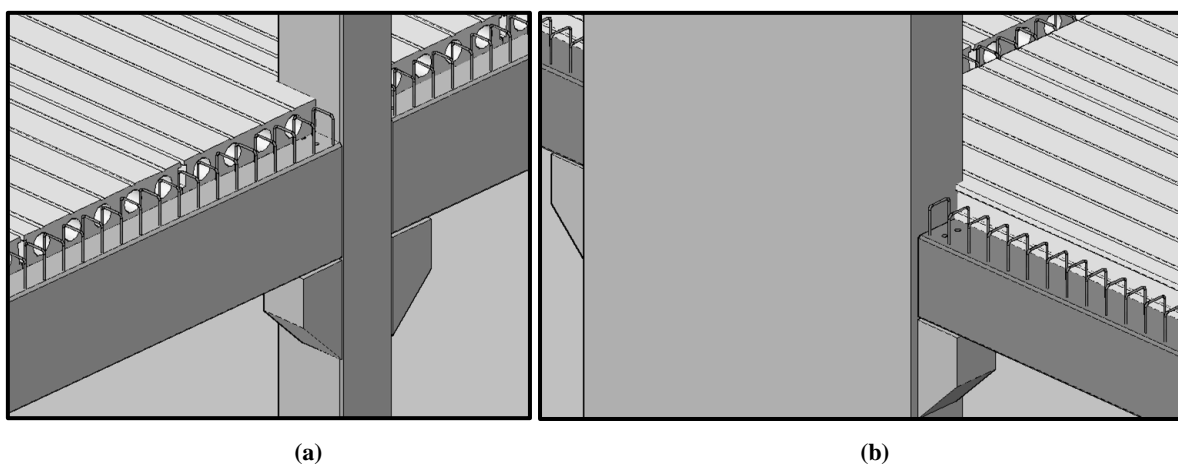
1 – Detalhes da conexão entre elementos: (a) Ligação rotulada existente entre pilares e vigas pré-fabricadas; (b) Ligação rotulada entre vigas e as paredes de cisalhamento.
